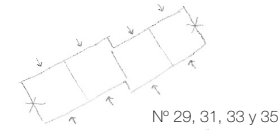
Bocetos en planta de la disposición de las construcciones situadas en la Rúa Bueu-Coia, nº 29, 31, 33 y 35 (autoría propia).
